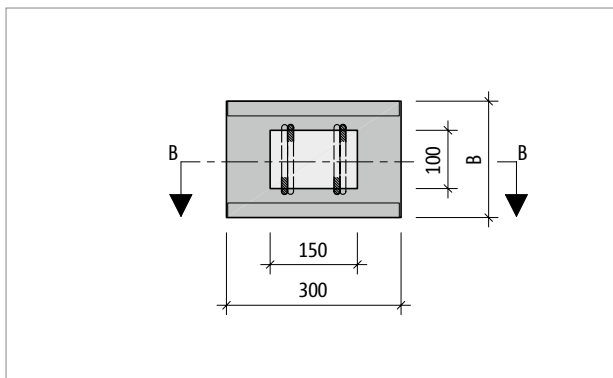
Schöck Sconnex® type W-N-VH : projection horizontale du produit ; surface de l'élément de compression 150 x 100 mm
